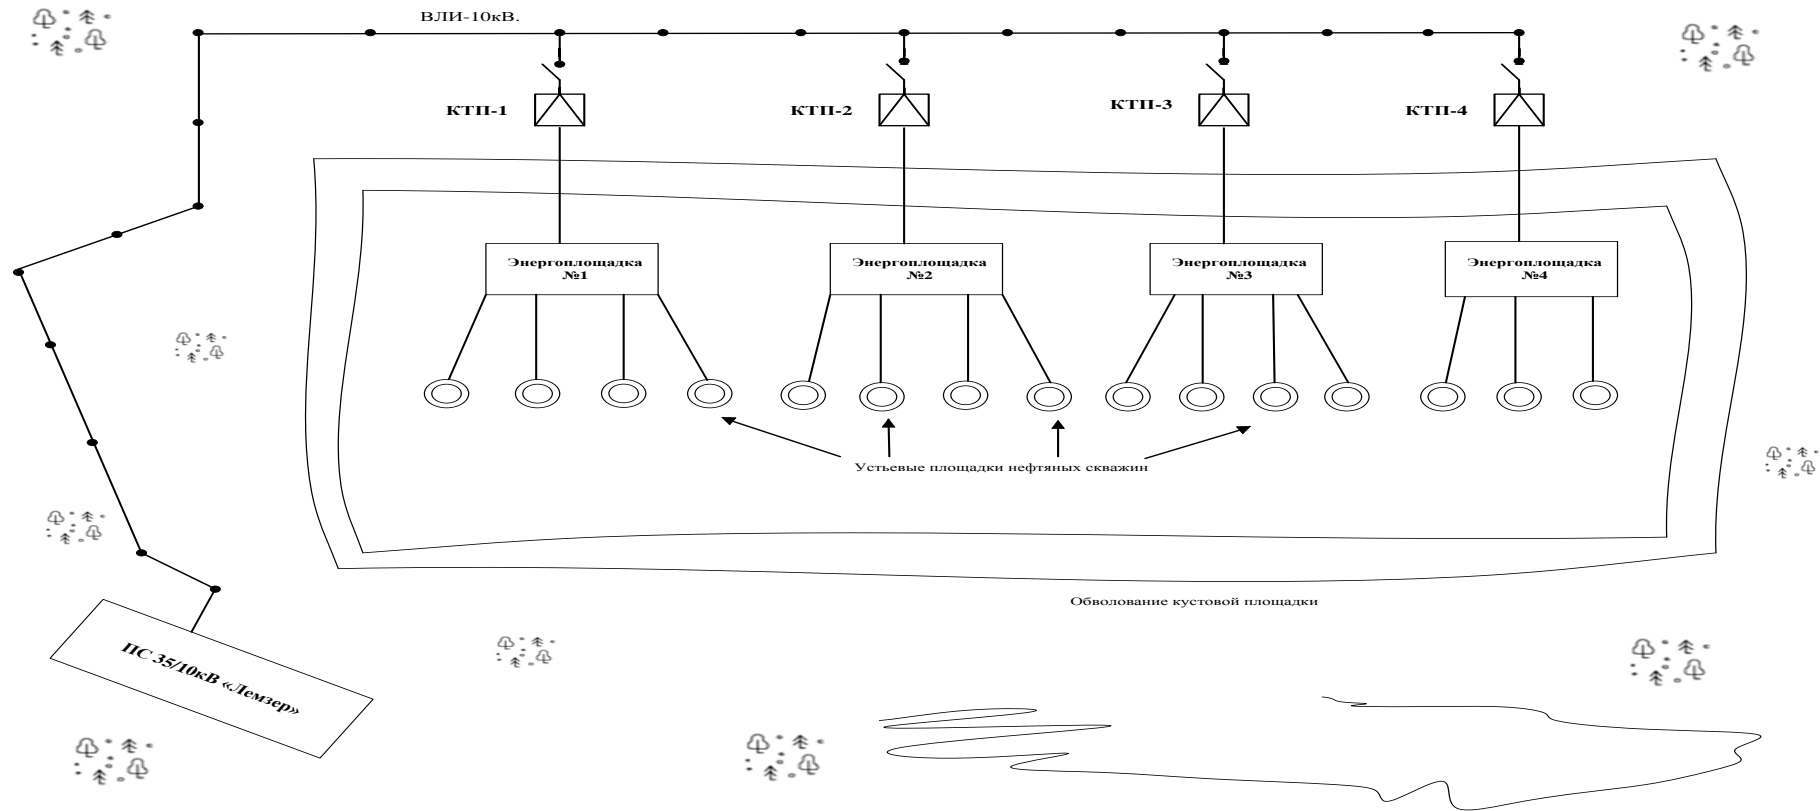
План расположения оборудования на кустовой площадке скважин
